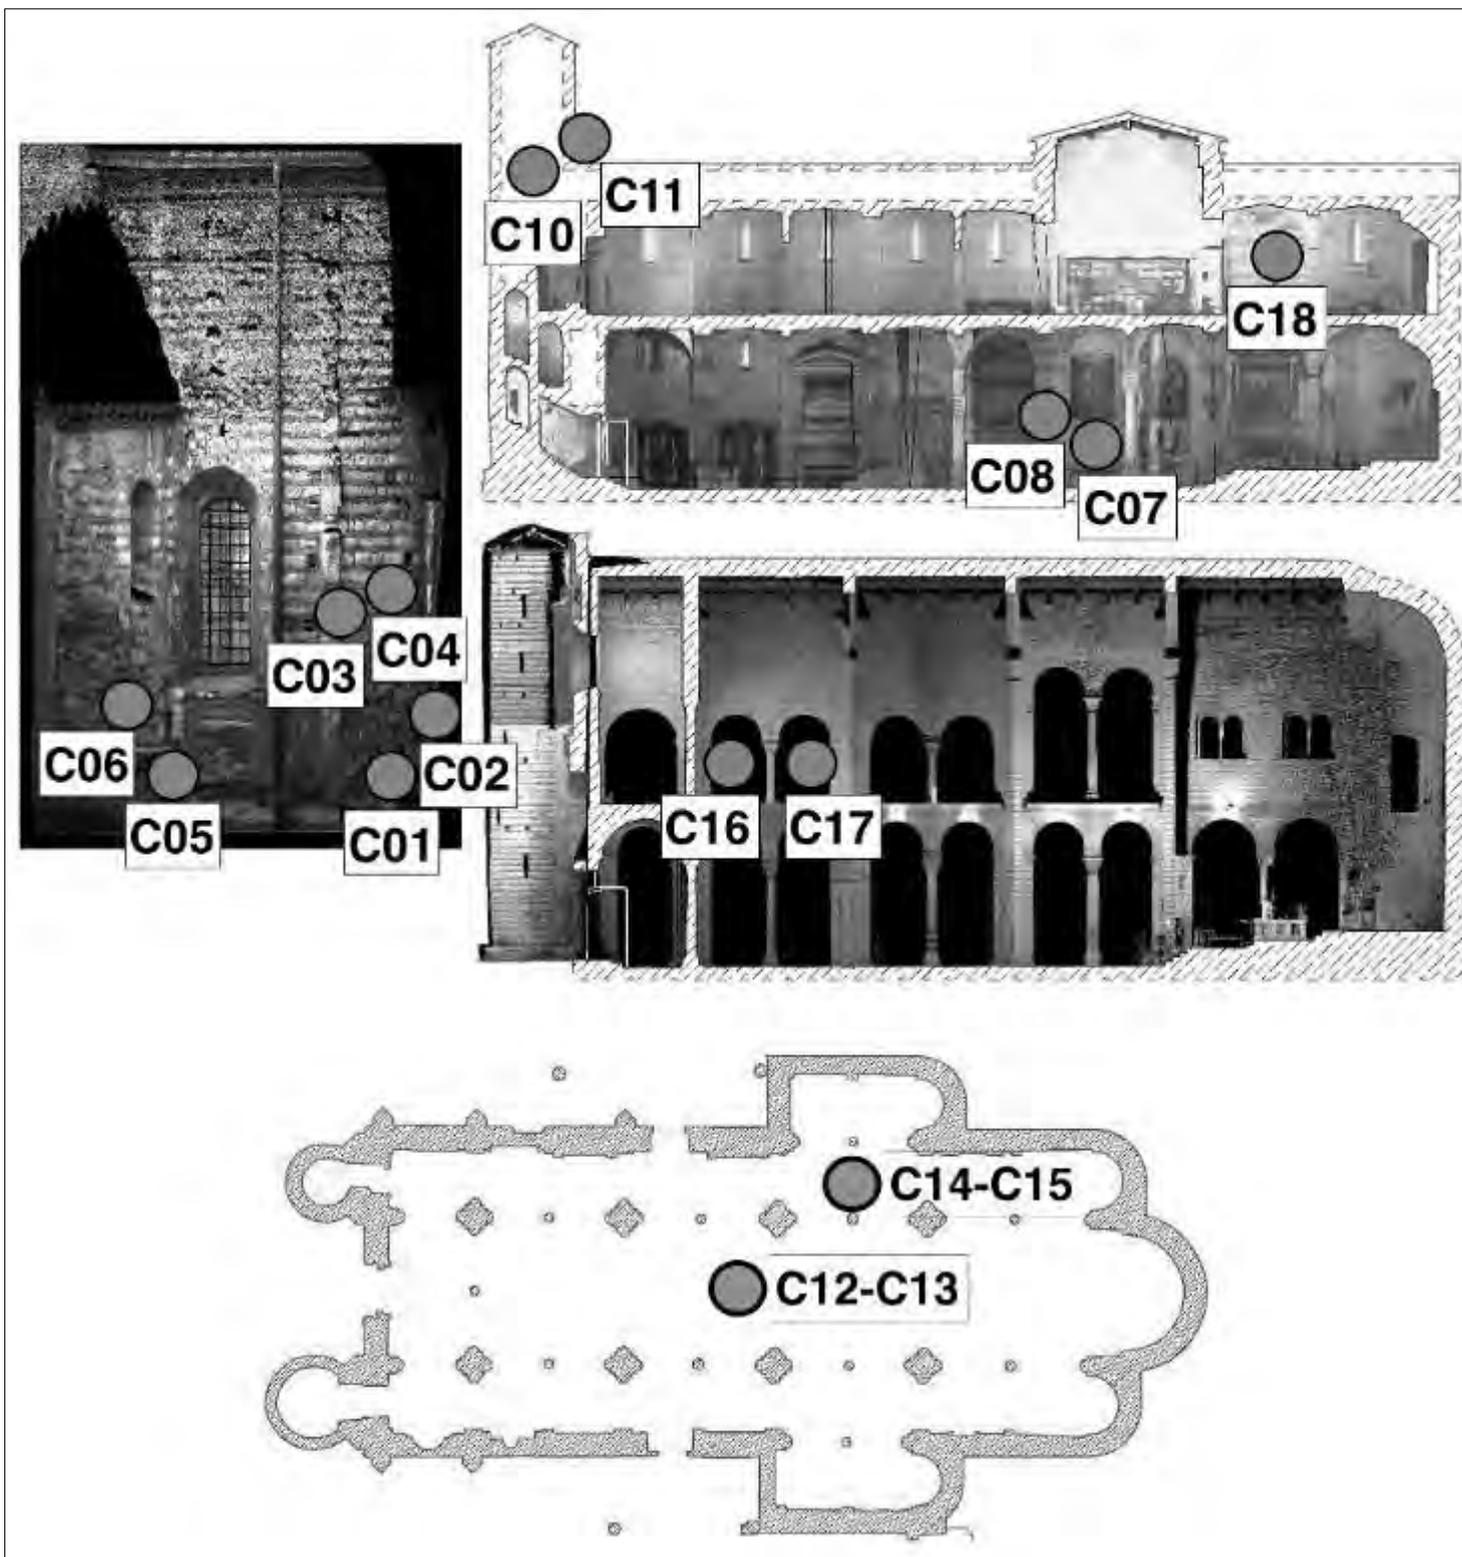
Punti di prelievo dei campioni in elevato (absidi, perimetrale nord, sezione longitudinale nord) e in pianta
